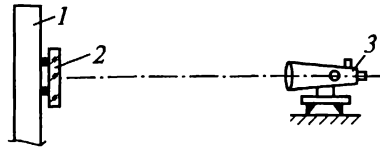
Схема установки конструкции по вертикали автоколлимационным способом:
